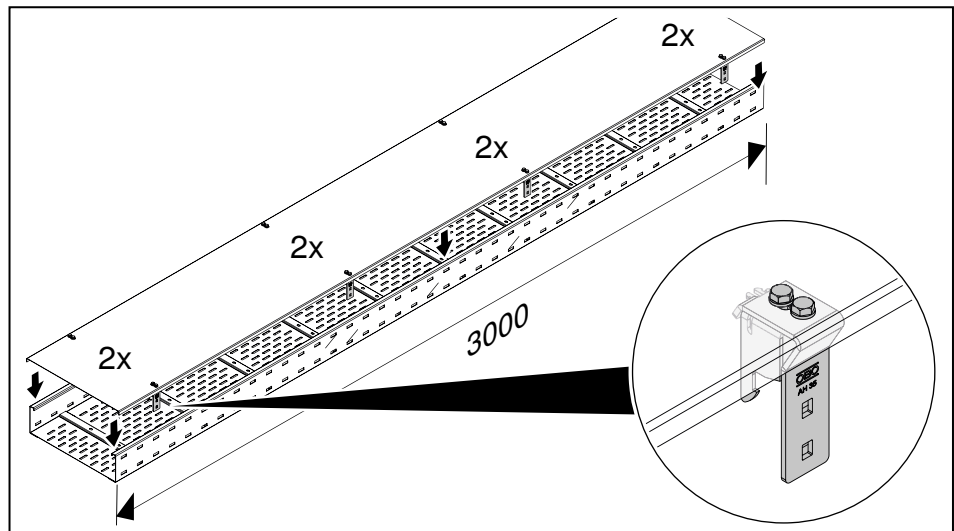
Установленный дистанционный держатель на крышке DRL FAM
